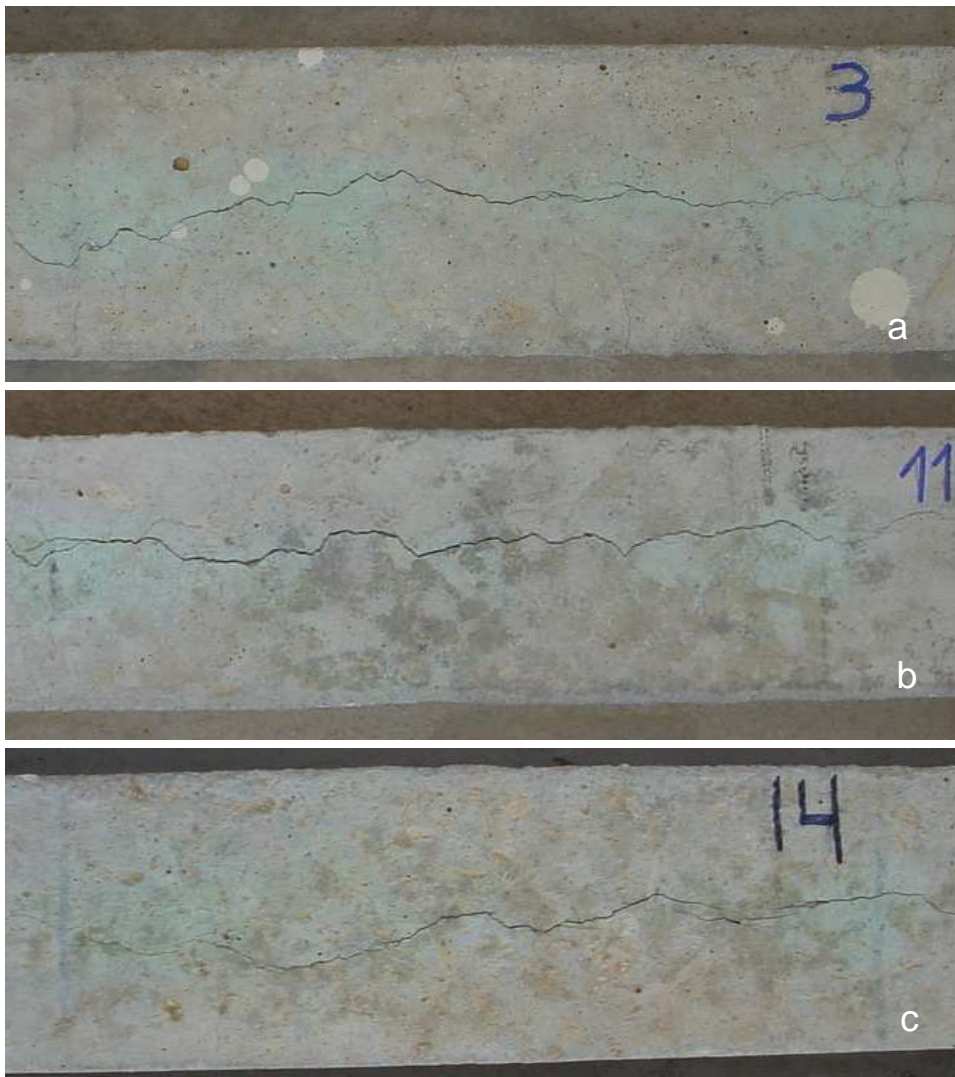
Fisuras observadas en vigas sin precarga a más
